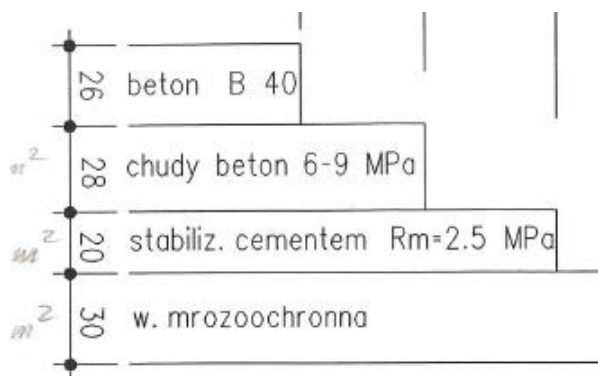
Schemat konstrukcji nawierzchni betonowej na liniach 1S , 1 2 w kierunku Katowic
